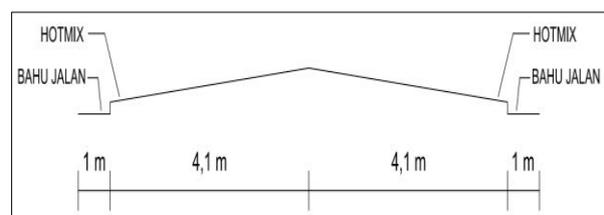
Geometrik Melintang Jalan D. I. Panjaitan Setelah Peningkatan Struktur Badan Jalan
